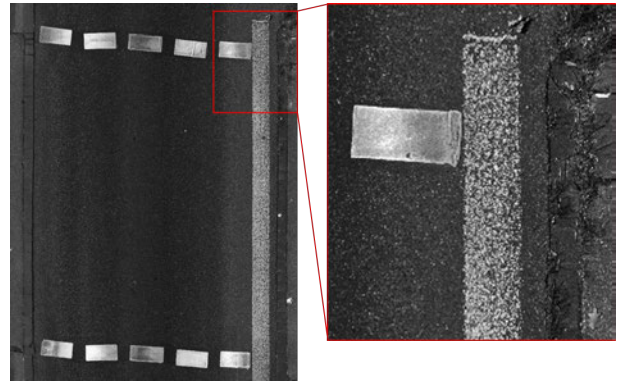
6 m Abschnitt eines Oberflächenbildes einer Straße mit Fahrbahnmarkierungen (links) und stark vergrößerter Ausschnitt zur Darstellung der Details (rechts).
